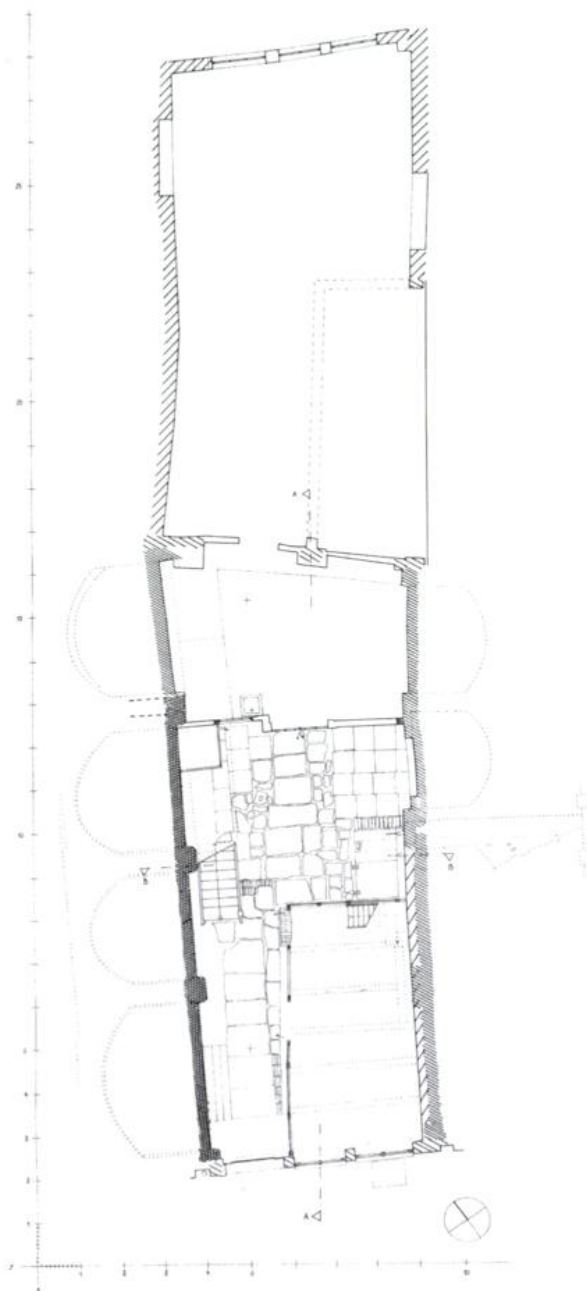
Grundriß Erdgeschoß Schnoor 14, Bestandsplan mit Baualterkartierung. Kreuzschraffur = älteste Bauphase.
